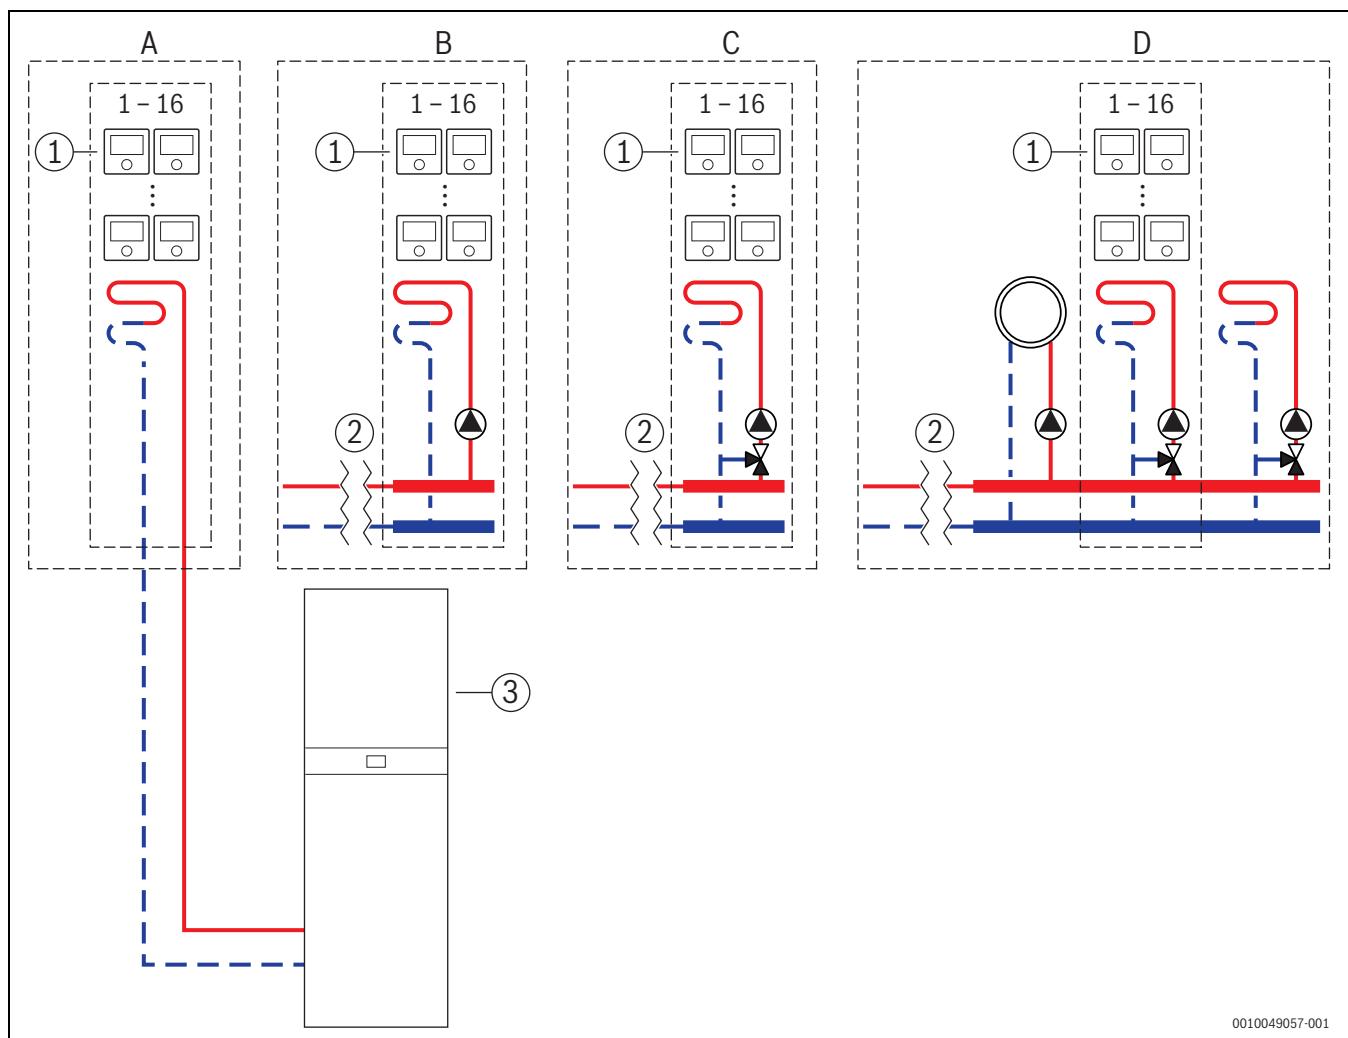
Schema dell'impianto (schema di principio non vincolante)
